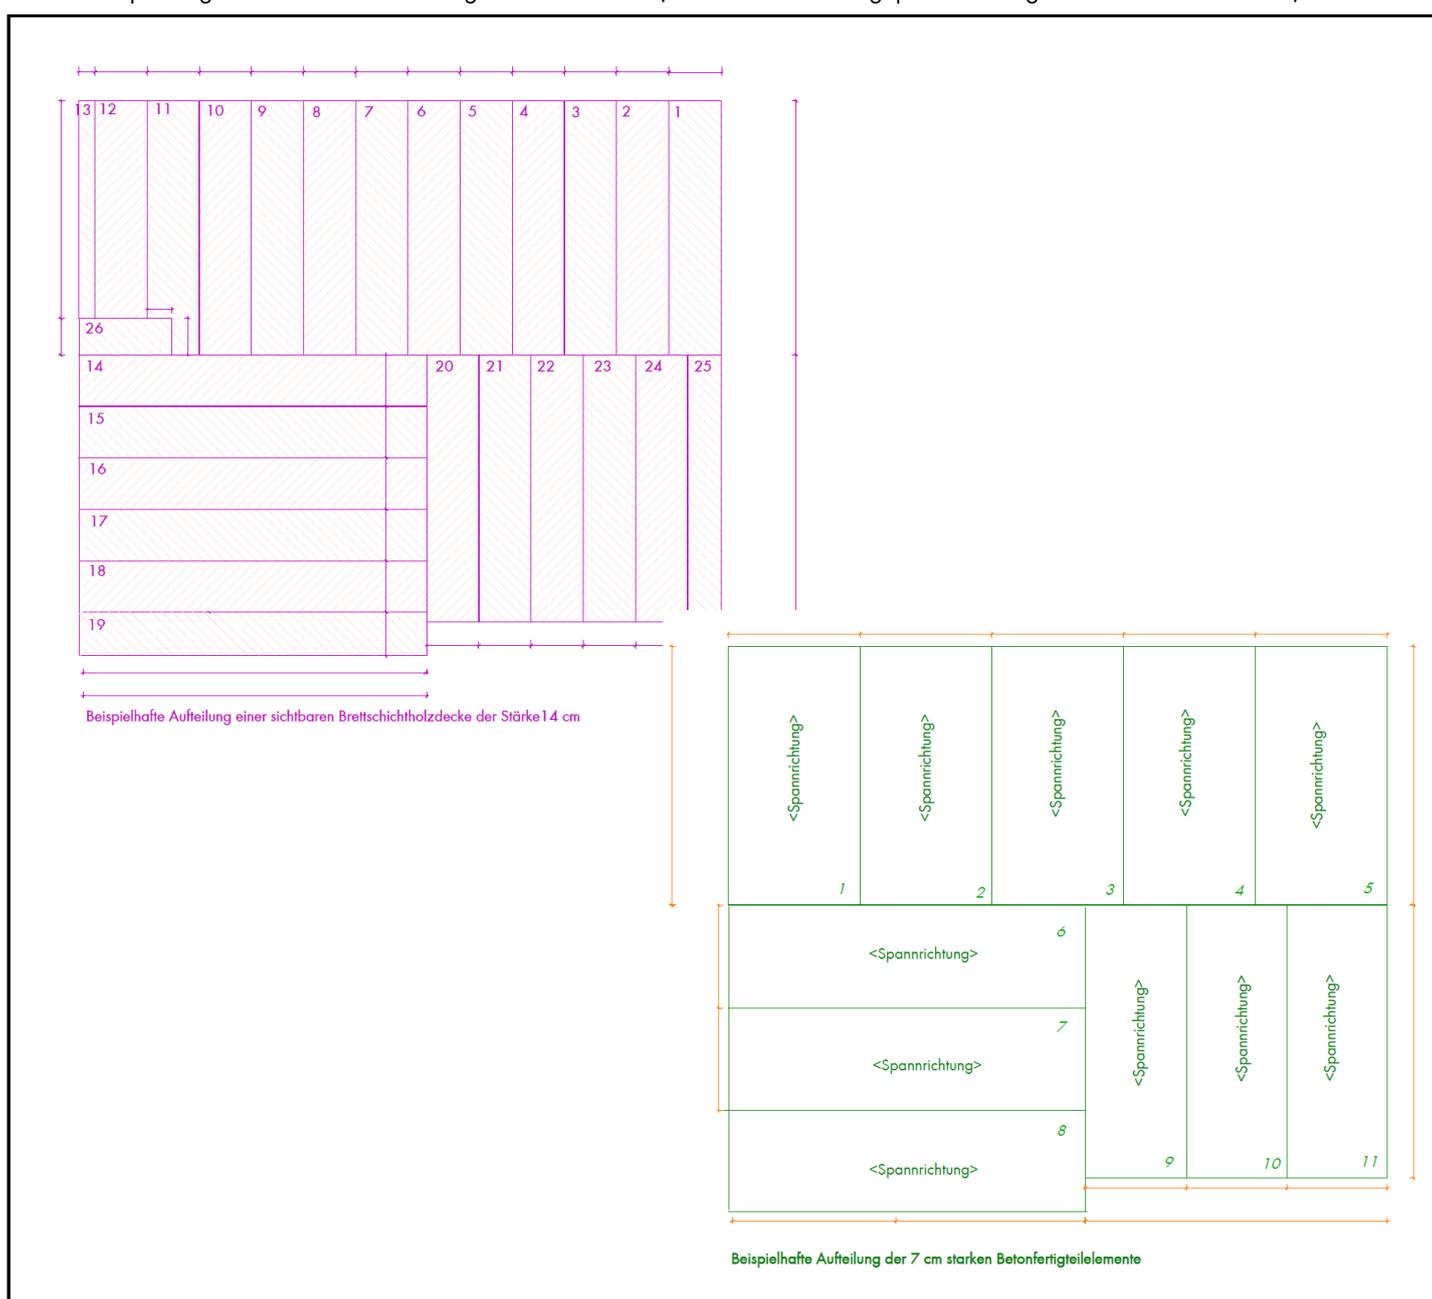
28: Beispielhafte Detailplanung der Holzkonstruktion und der Betonfertigteile
